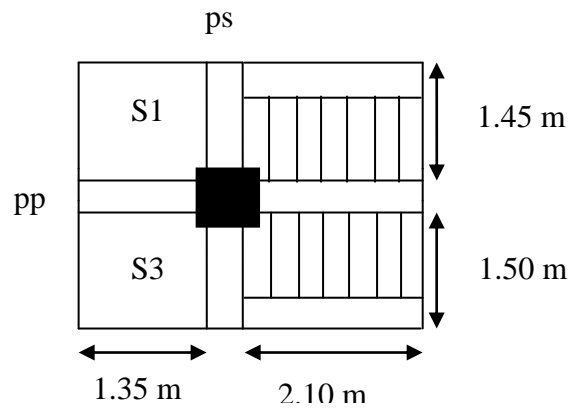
Surface afférente du poteau 3 (présence de l'escalier duplex)
